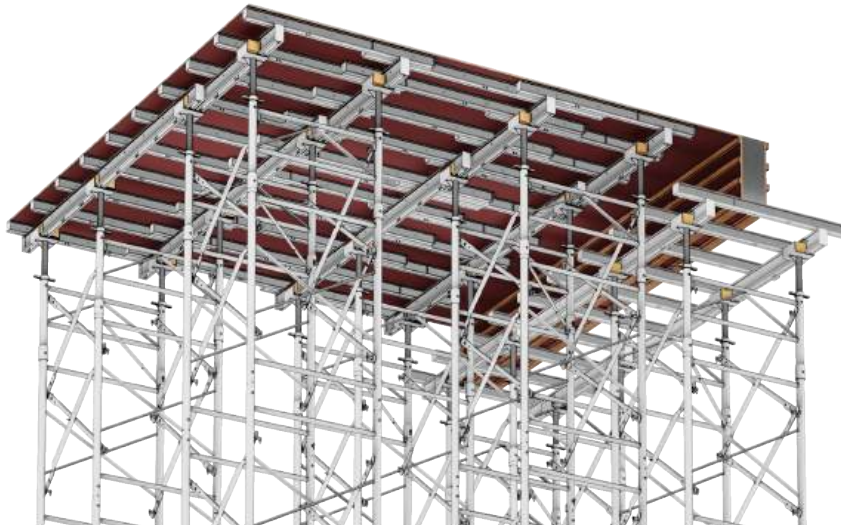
Escoramento de lajes sobre o apoio das vigas
